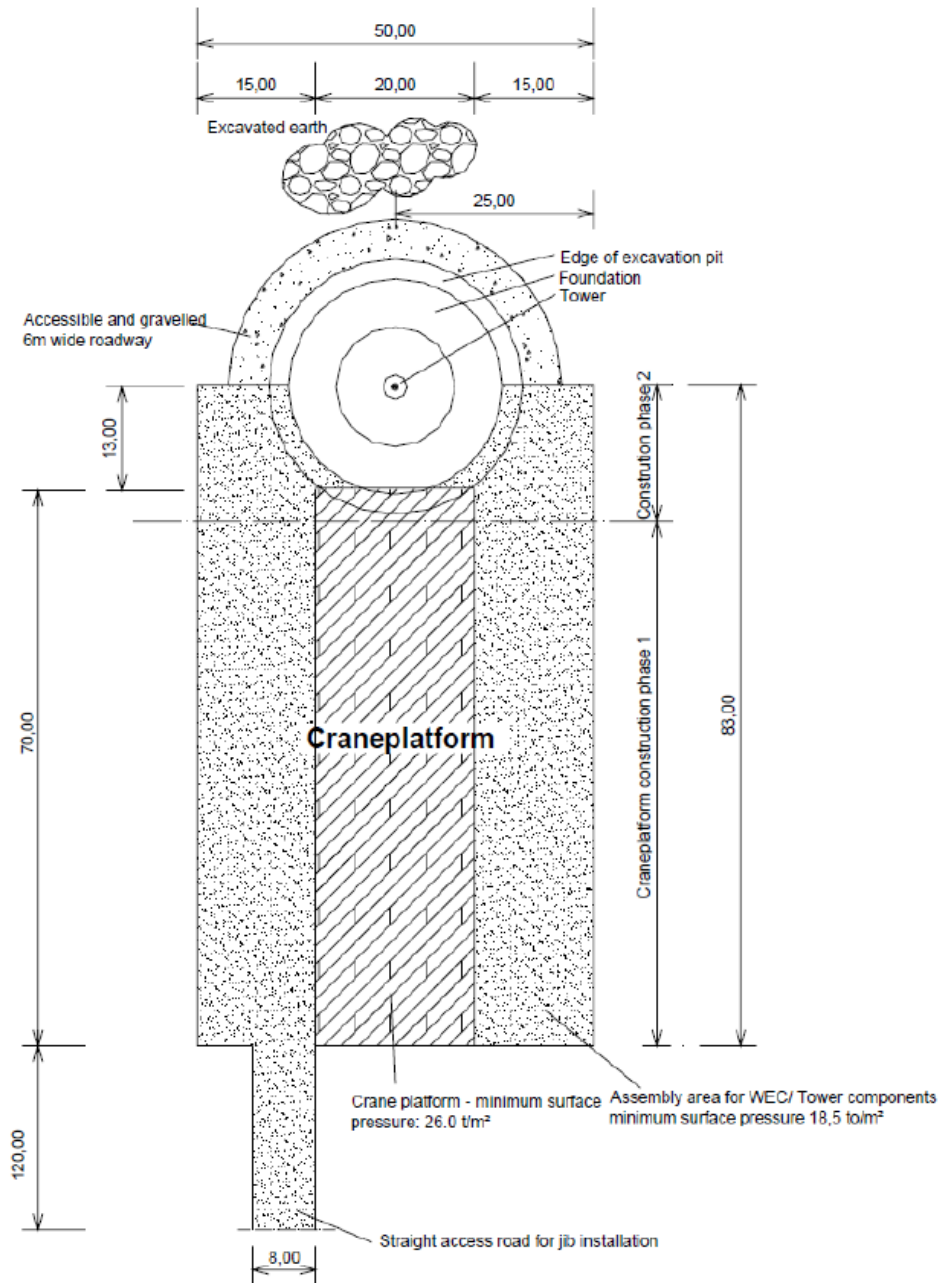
Disposizione delle gru rispetto alle fondazioni ed all'autoarticolato
